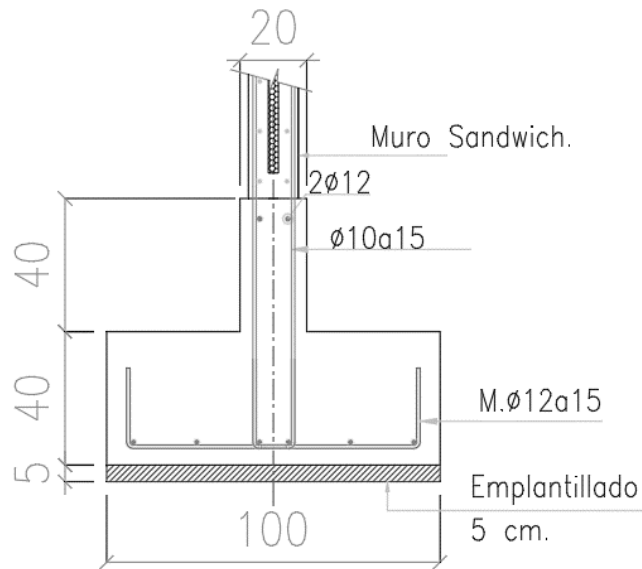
Detalle zapata corrida bajo muro sándwich.
